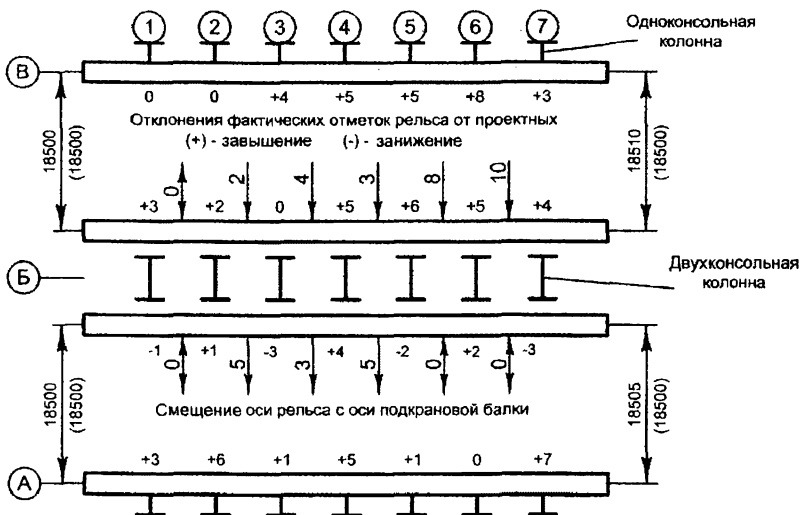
Исполнительная схема подкрановых рельсов мостового крана
